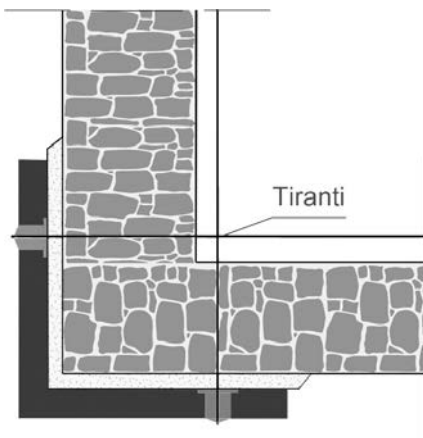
Vista in pianta di doppio tirante d'angolo.
